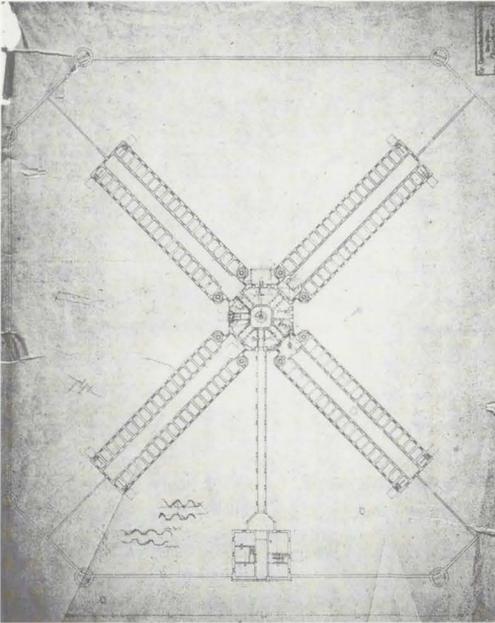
Zweiter Entwurf, unbez. u. unsign. Grundriss Erdgeschoss. GLA, G Bruchsal 40.
